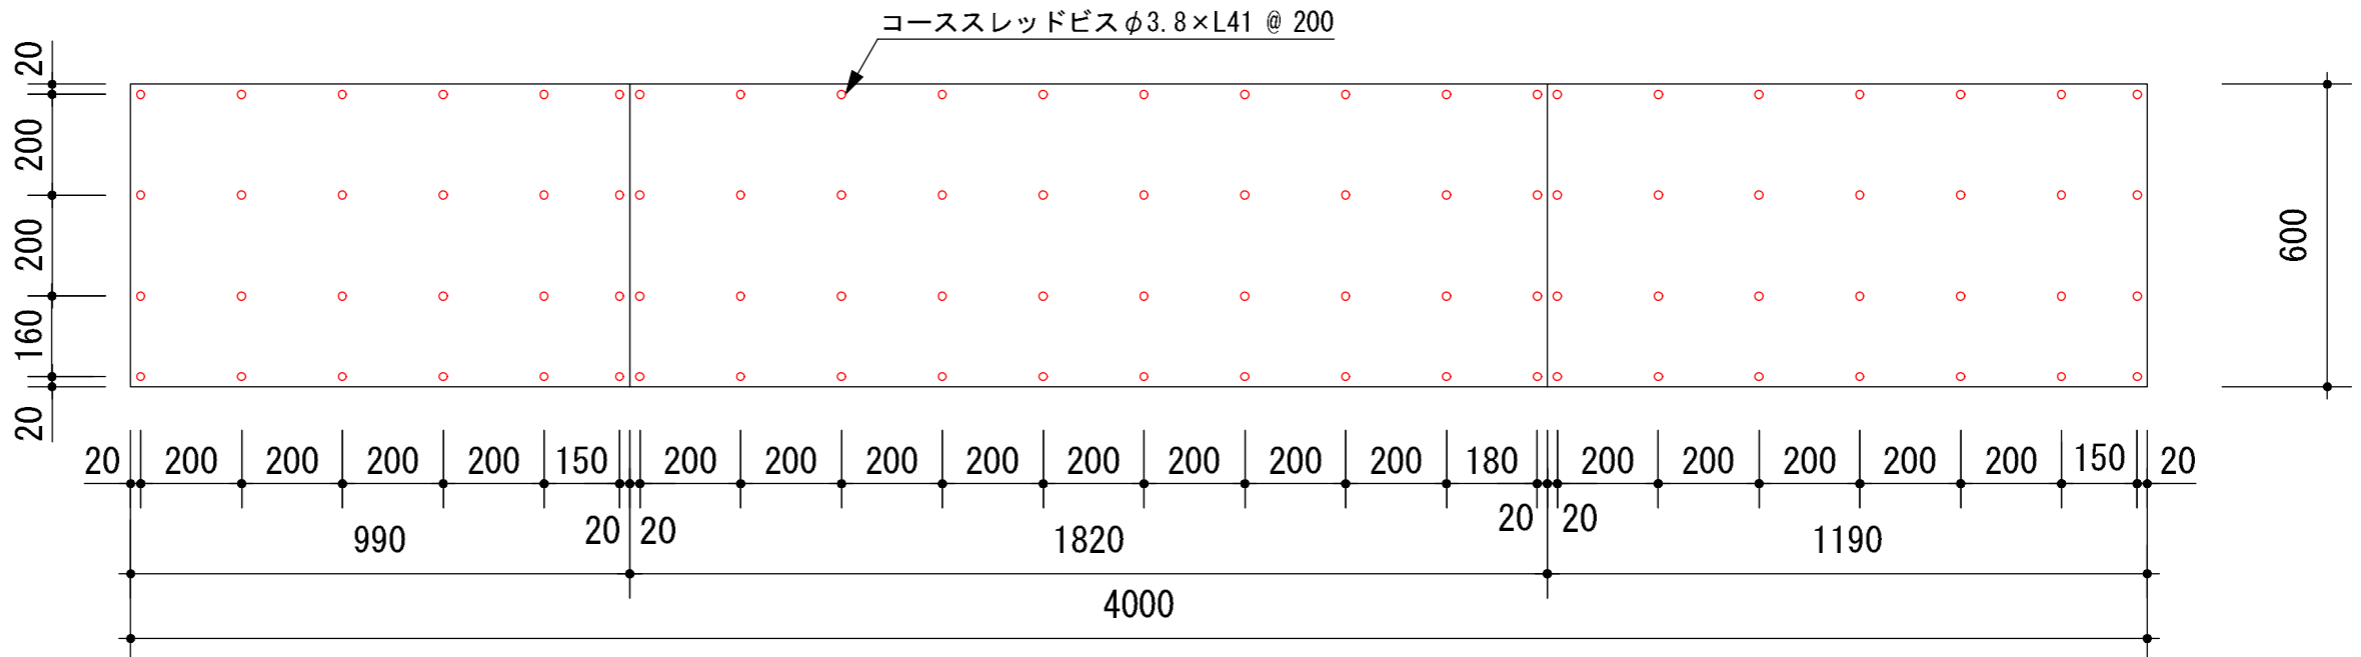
木造梁耐火試験用試験体 割付図 (寸法:mm)
